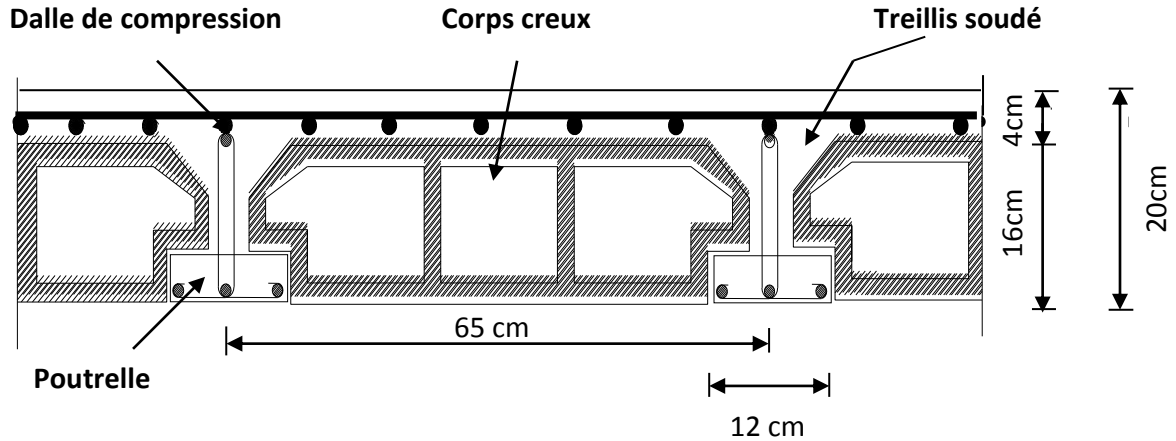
Schéma descriptif d'un plancher en corps creux.
